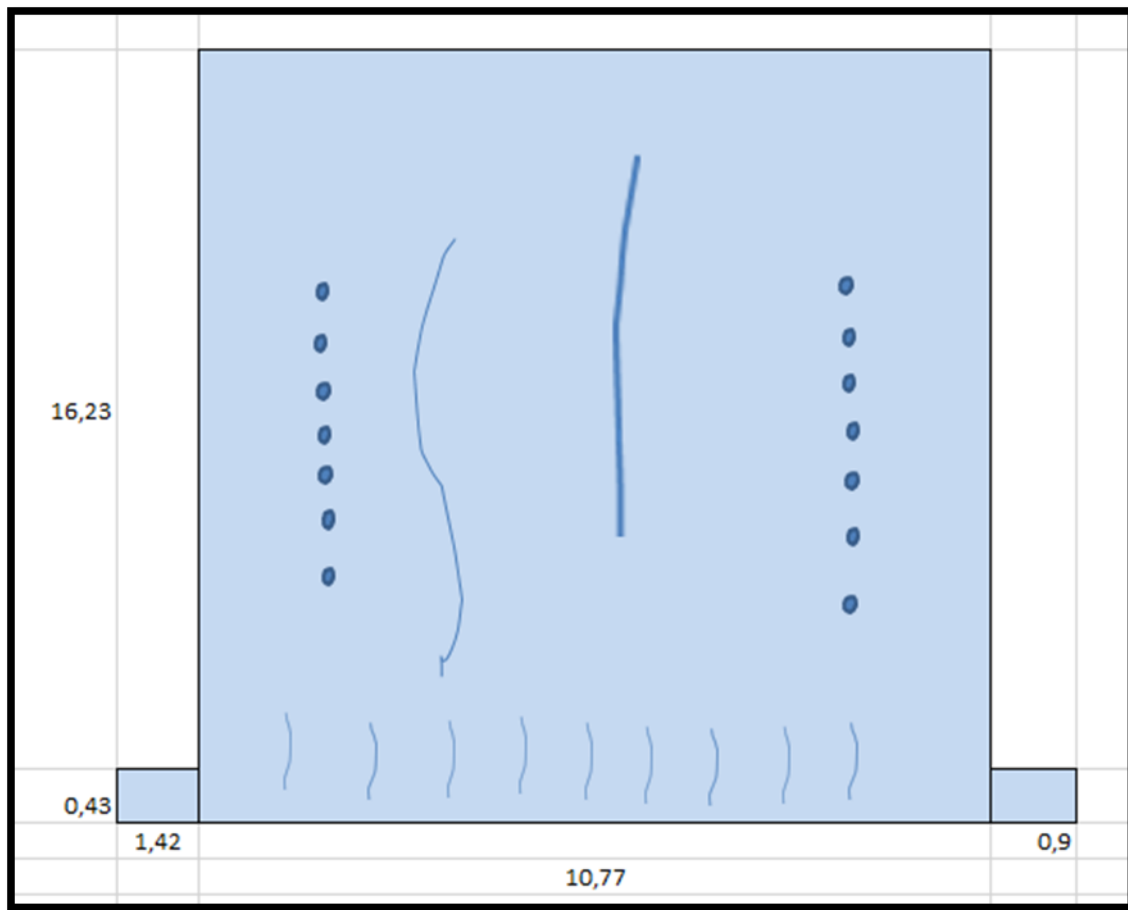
Alzado de la TE-2940 con sus elementos y levantamientos de lesiones del costado norte
